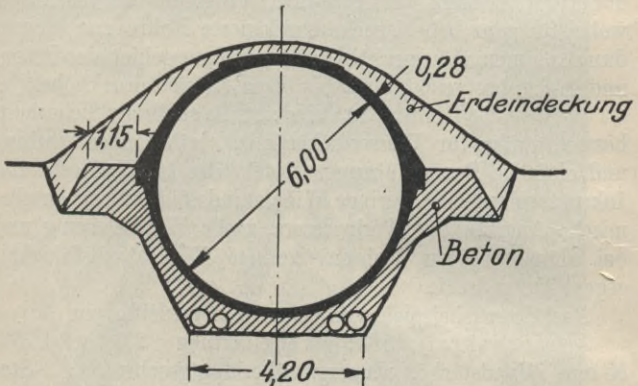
Eisenbeton-Druckrohrleitung der Wasserkraftanlage Drac-Romanche.
